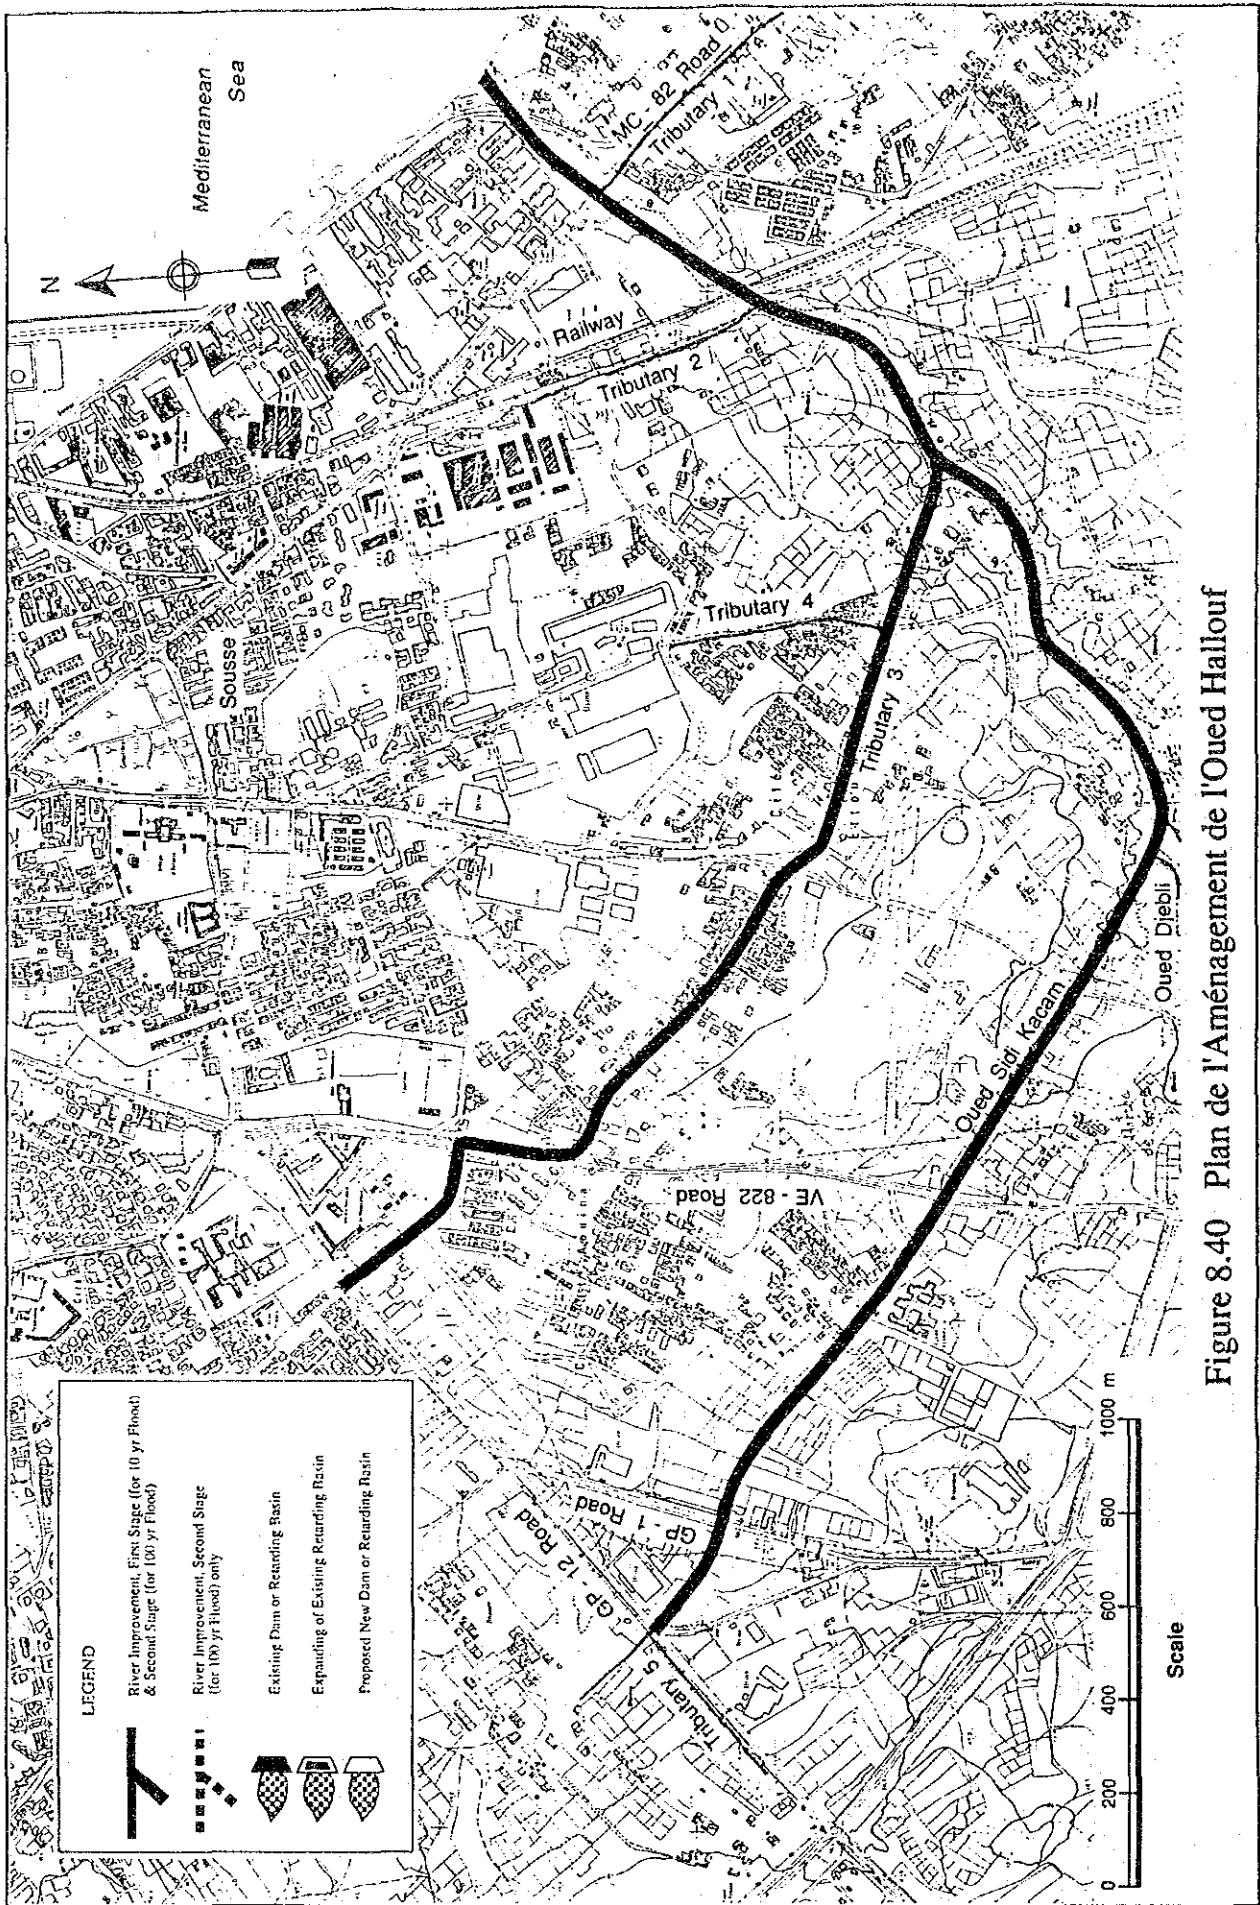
Plan de l'Aménagement de l'Oued Hallouf
